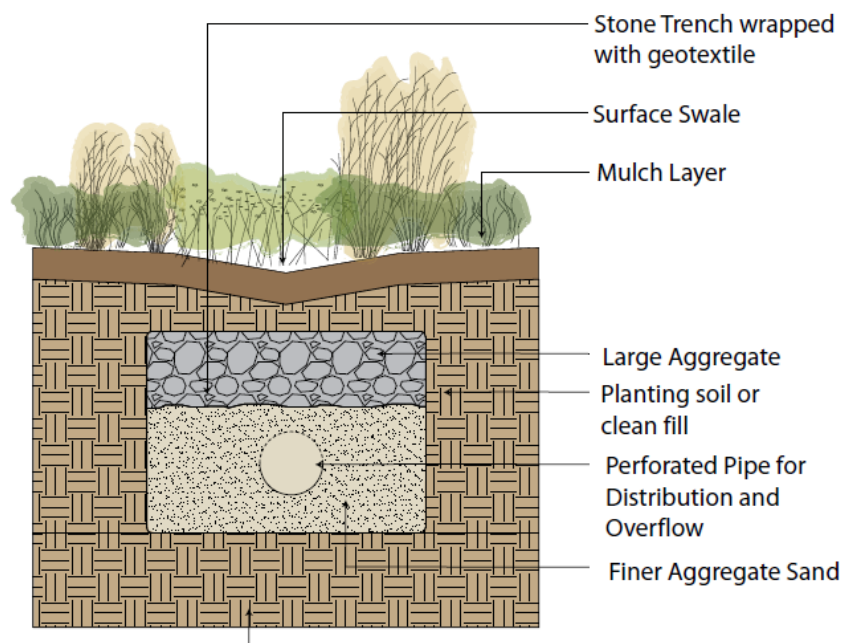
Corte esquemático de uma trincheira de infiltração (NYC Department of Design and Construction, 2008)
